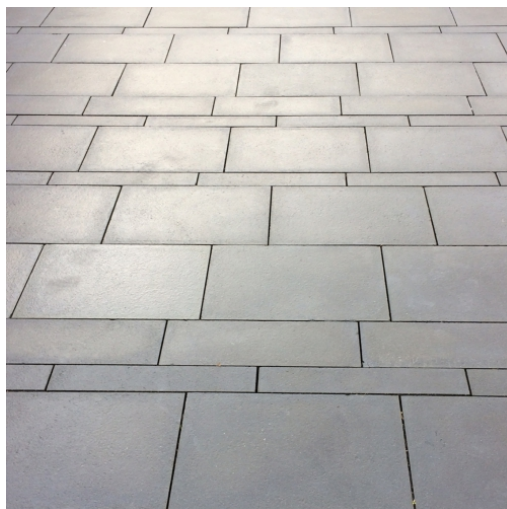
LAJES DE BETÃO RECICLADO
